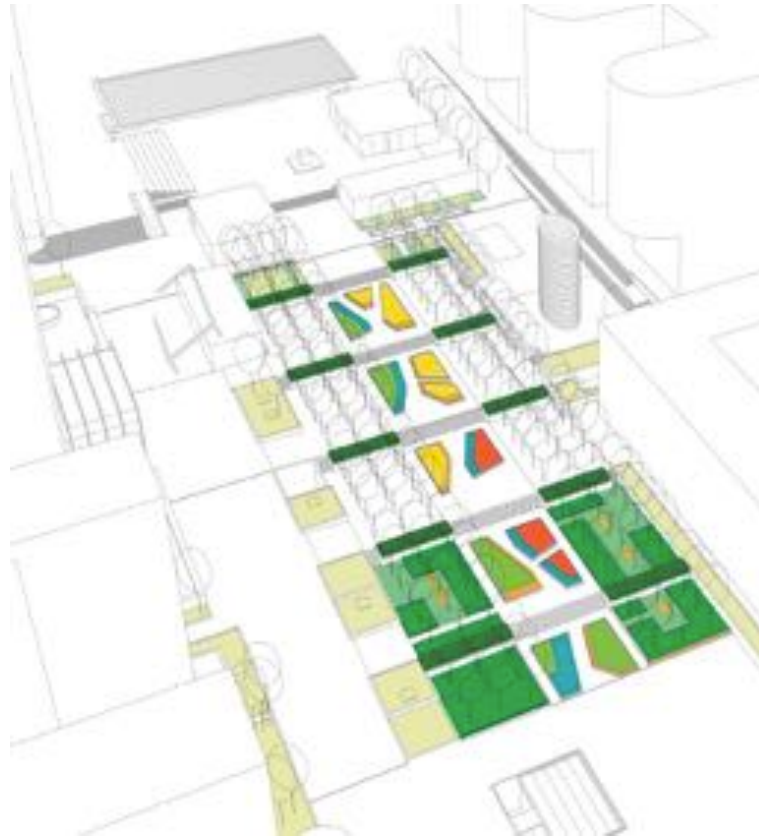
en haut : Jardins sur dalle « Séquence Agam », plan par l'Atelier Foïs (source : <https://www.atelierfois.com/info.html>)
